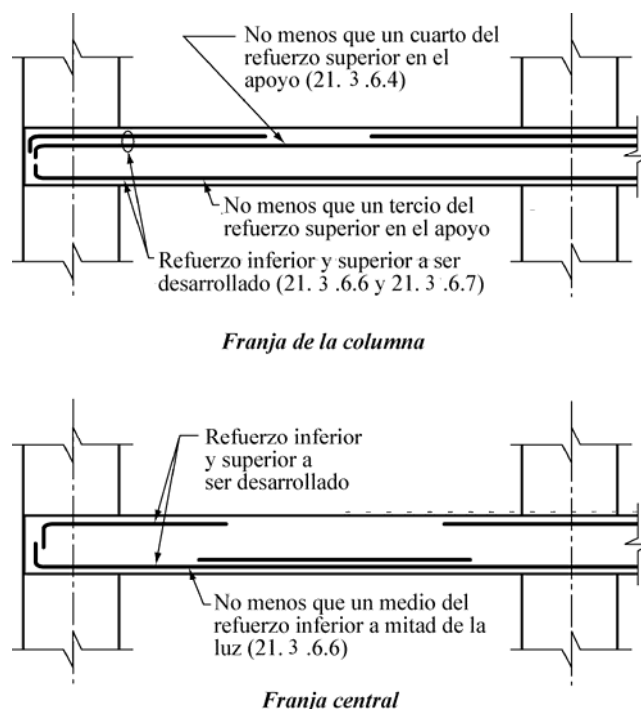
Disposición del refuerzo en losas
